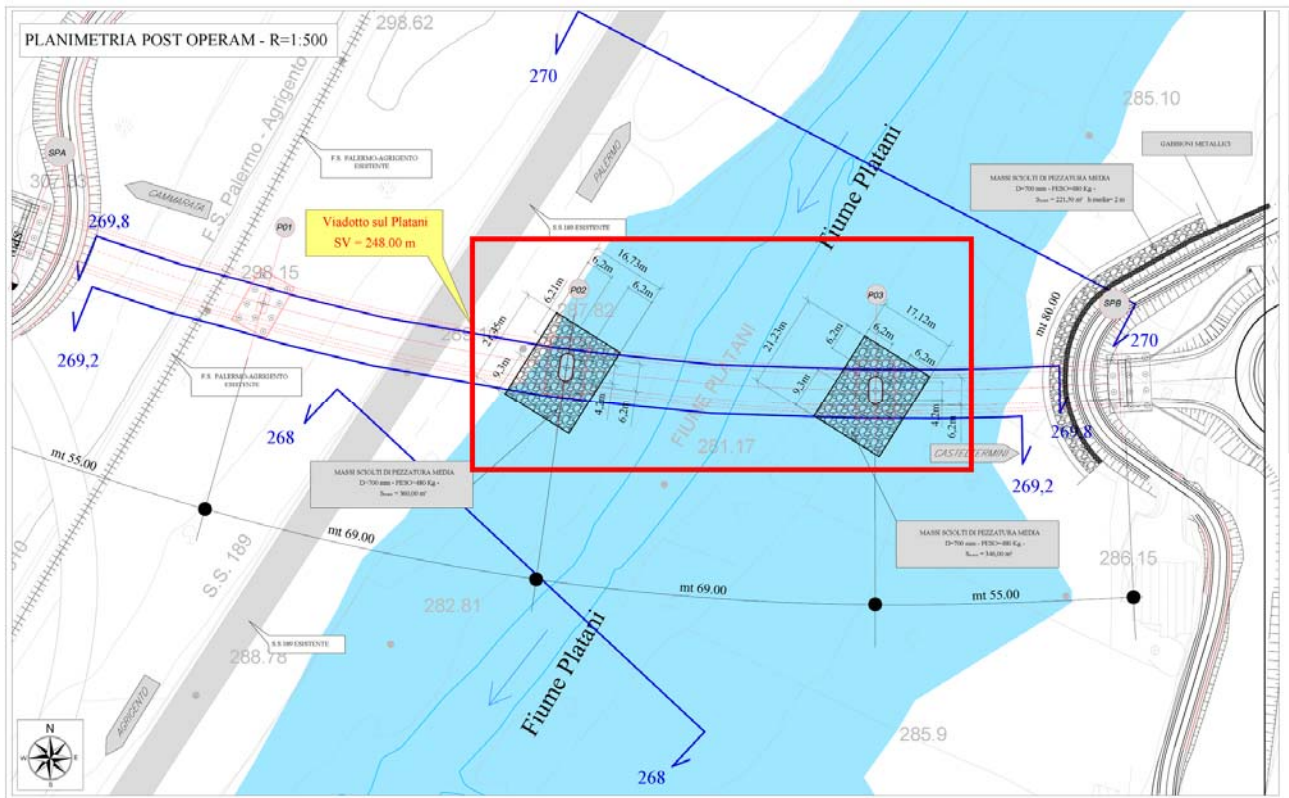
Planimetria post Operam Viadotto sul Platani: in rosso si evidenzia l'estensione in pianta della protezione in riprap.
